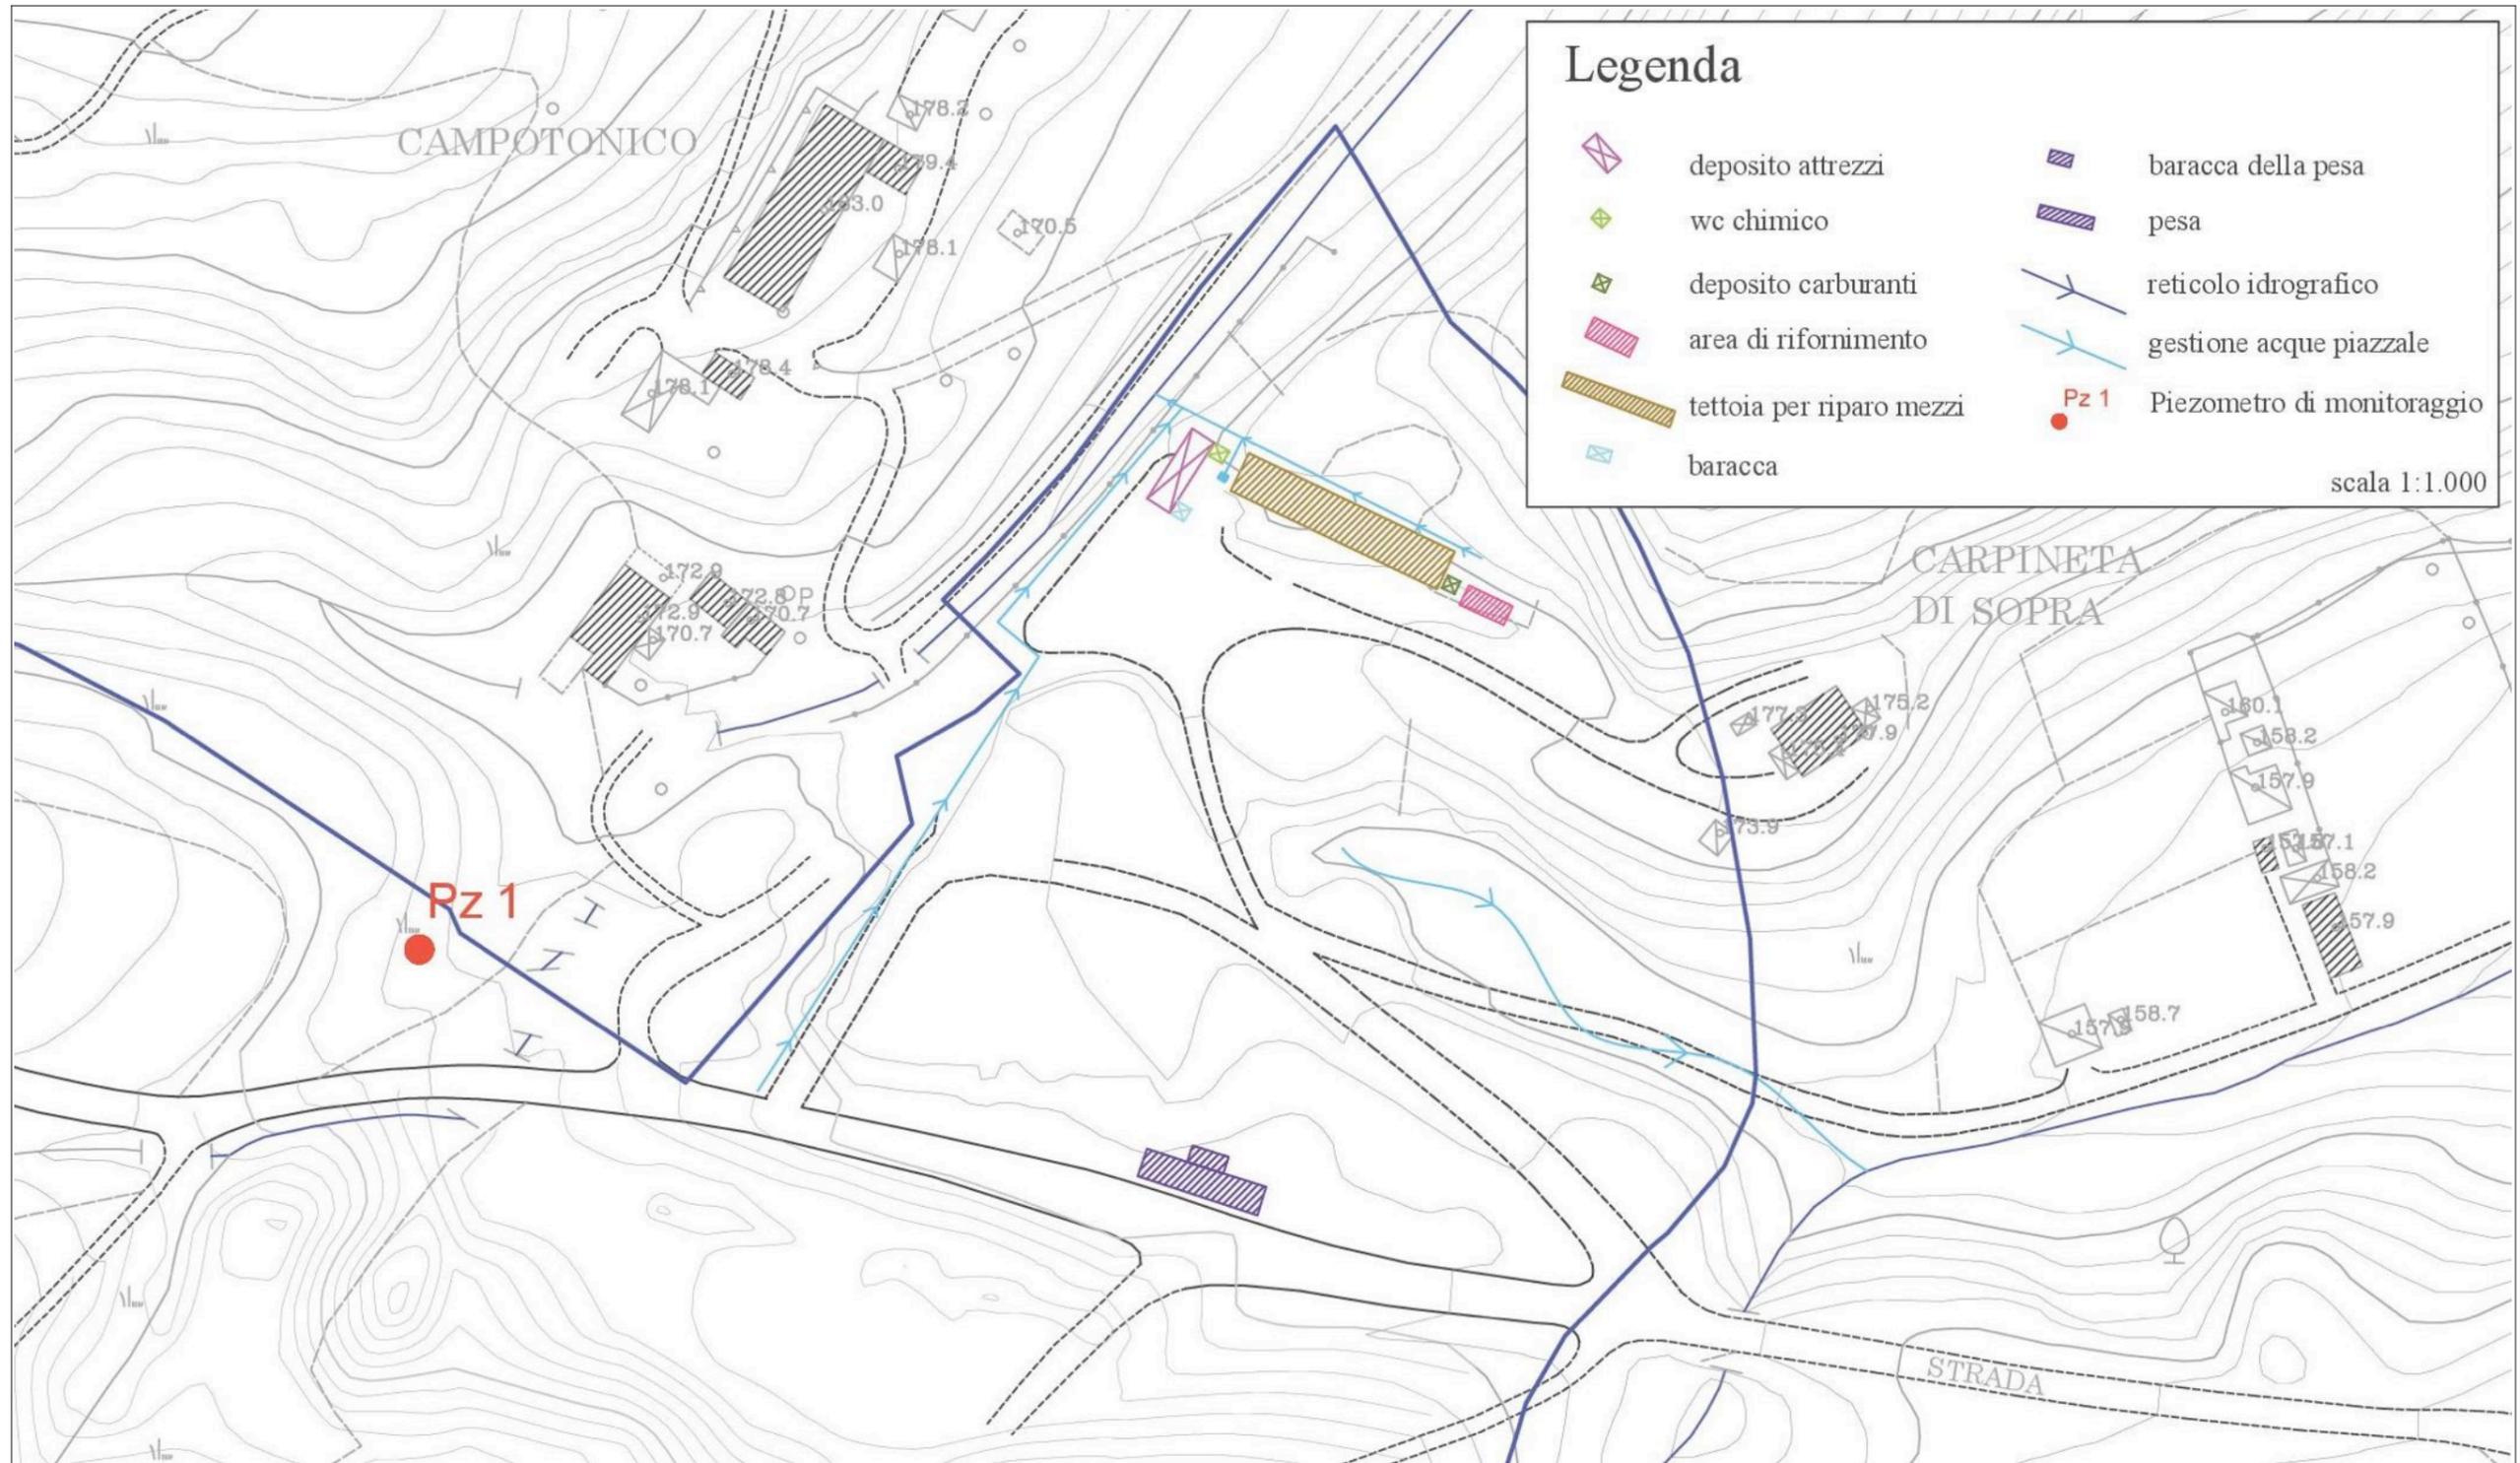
Ubicazione prevista del piezometro e della piastra in calcestruzzo per i rifornimenti.
